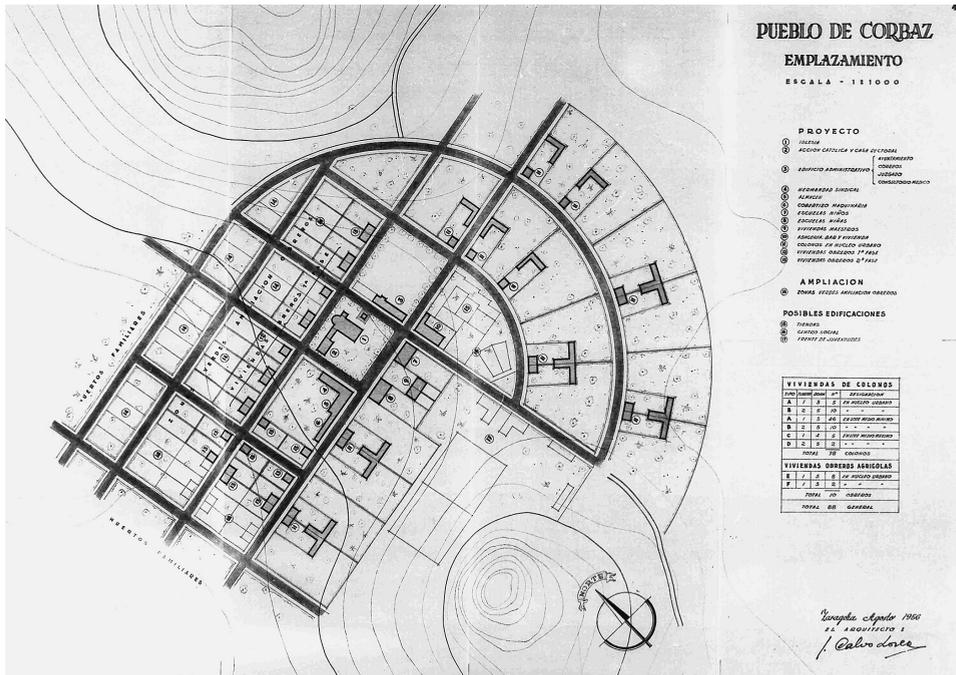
Planta general del pueblo de Curbe (Huesca), por el arquitecto Javier Calvo Lorea, 1956 (A.C.M.A.G.R.A.M.A.).
